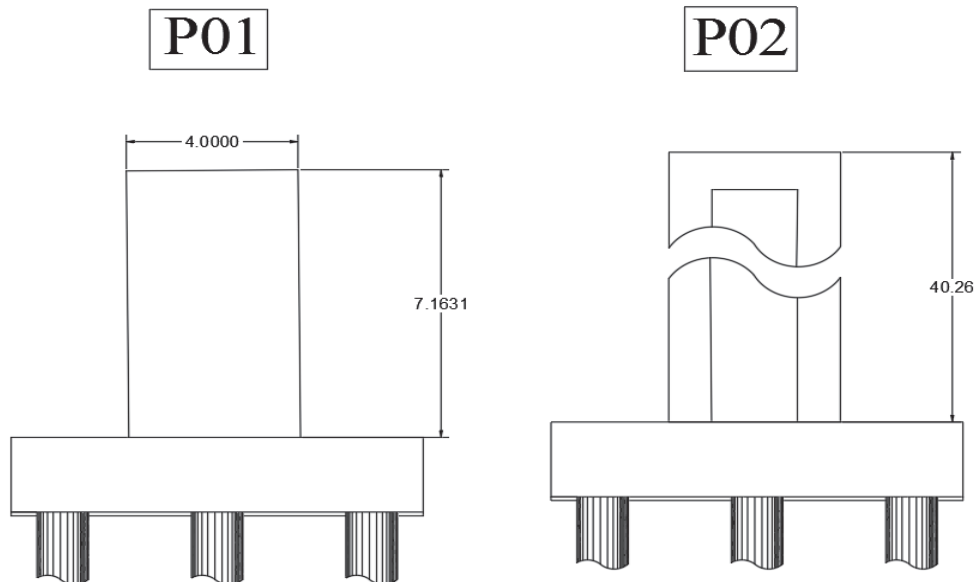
les dimensions de la pile la plus haute « P02 ».
